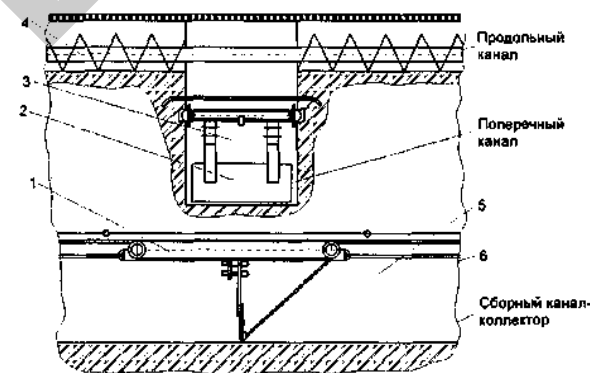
Конвейер скребковый универсальный КСУ-Ф-1:
